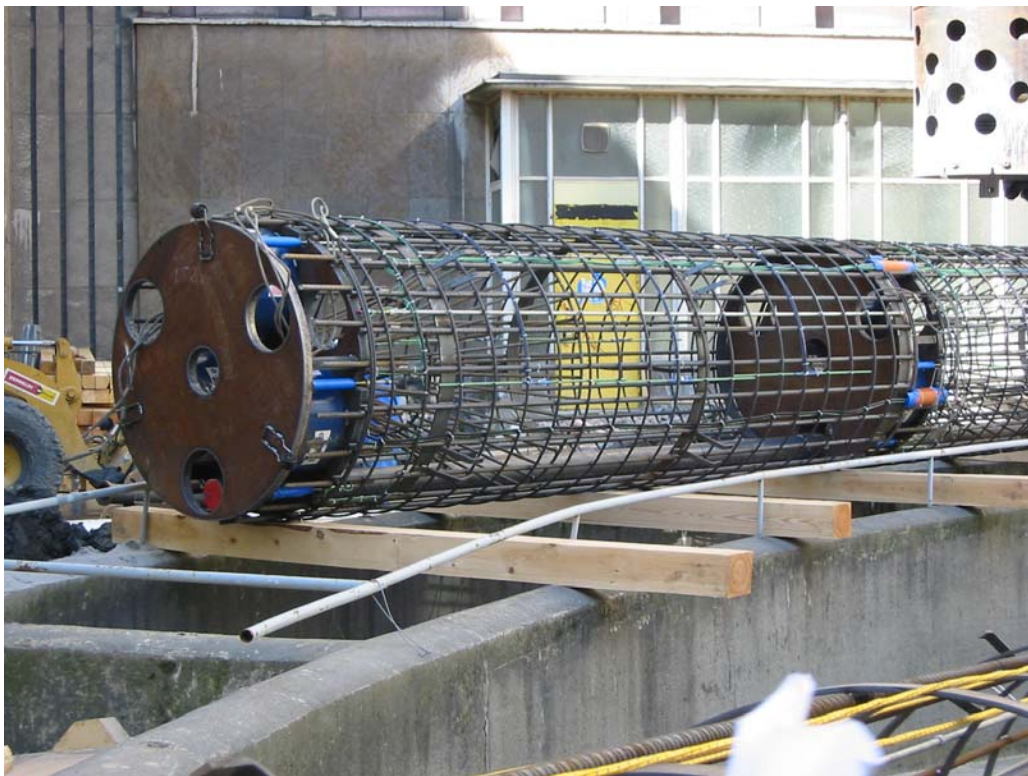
Foto des Bewehrungskorbes mit den zwei Pressenebenen vor dem Einbau
